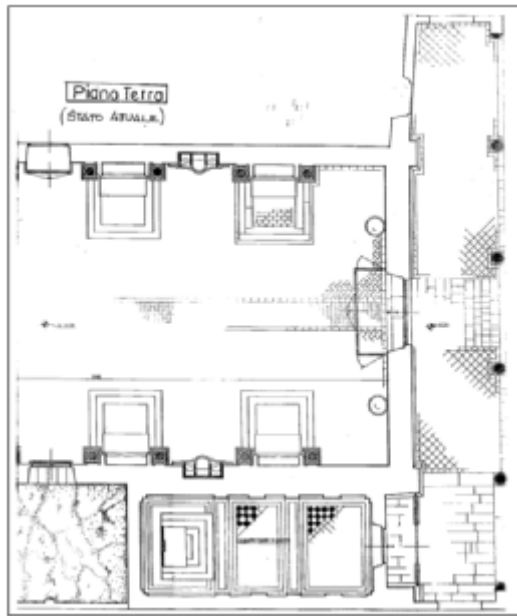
Rilievo architettonico (particolare). (Fonte: Progetto di manutenzione straordinaria e consolidamento della Chiesa di S.M.a Carmignano, Arch. C.F. Matteucci, Ing. L. Lotti, 1986).
